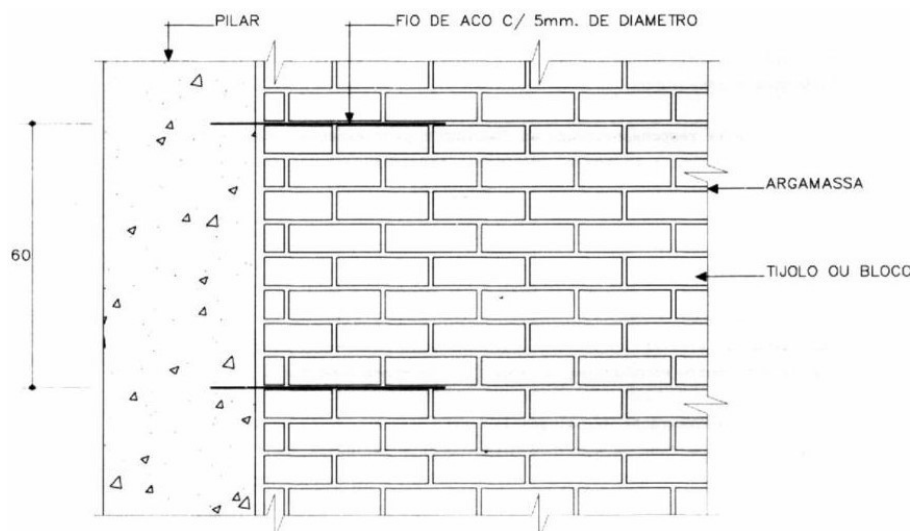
Detalhe ligação de alvenaria com pilares de concreto
